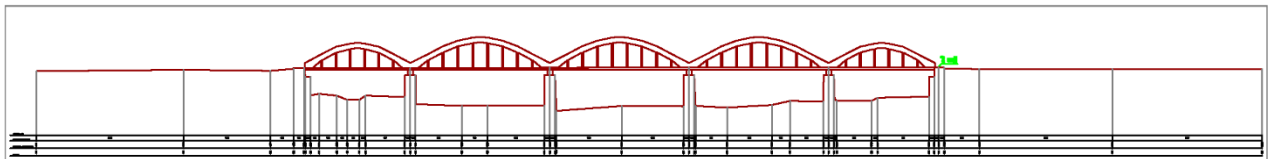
Sezione rilevata dai topografi, ponte exSS106 (sezione 3) (per gentile concessione di F. Macchione)
